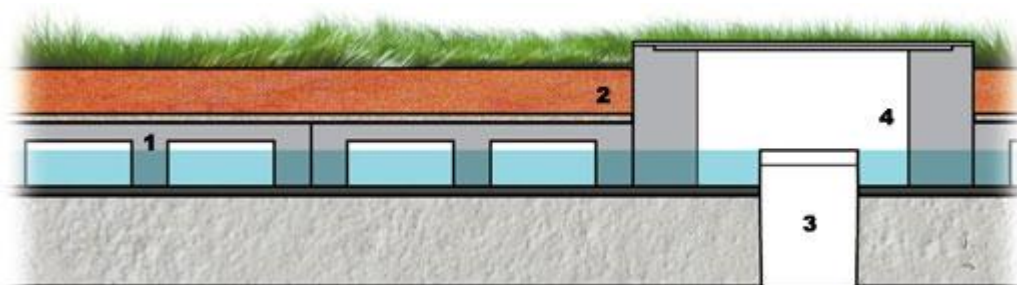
Esquema estrutural laminar do telhado verde Ecotelhado.
